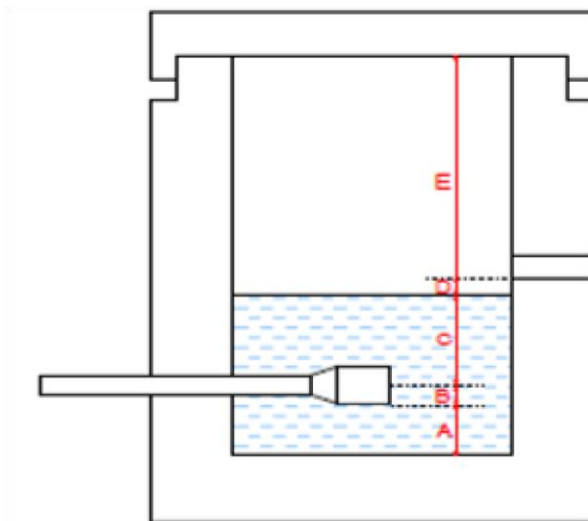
Cálculo de la cámara húmeda de una captación tipo ladera.
